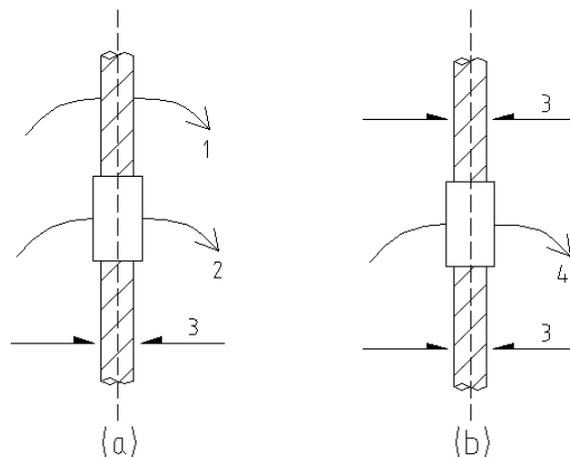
钢筋直螺纹连接接头拧紧操作示意图
